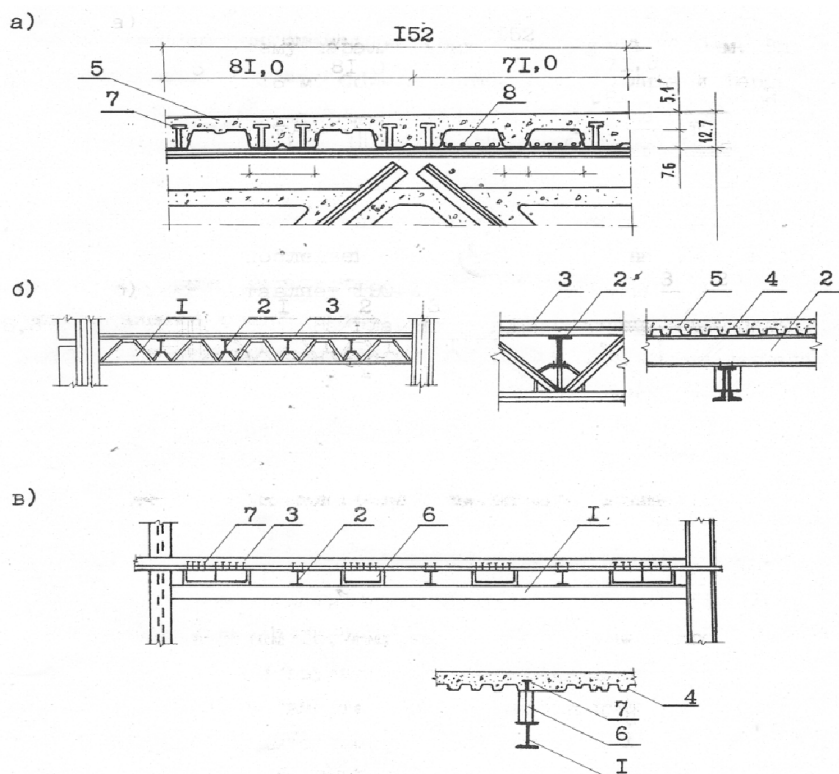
Конструкции комбинированных перекрытий, возводимых в США.
